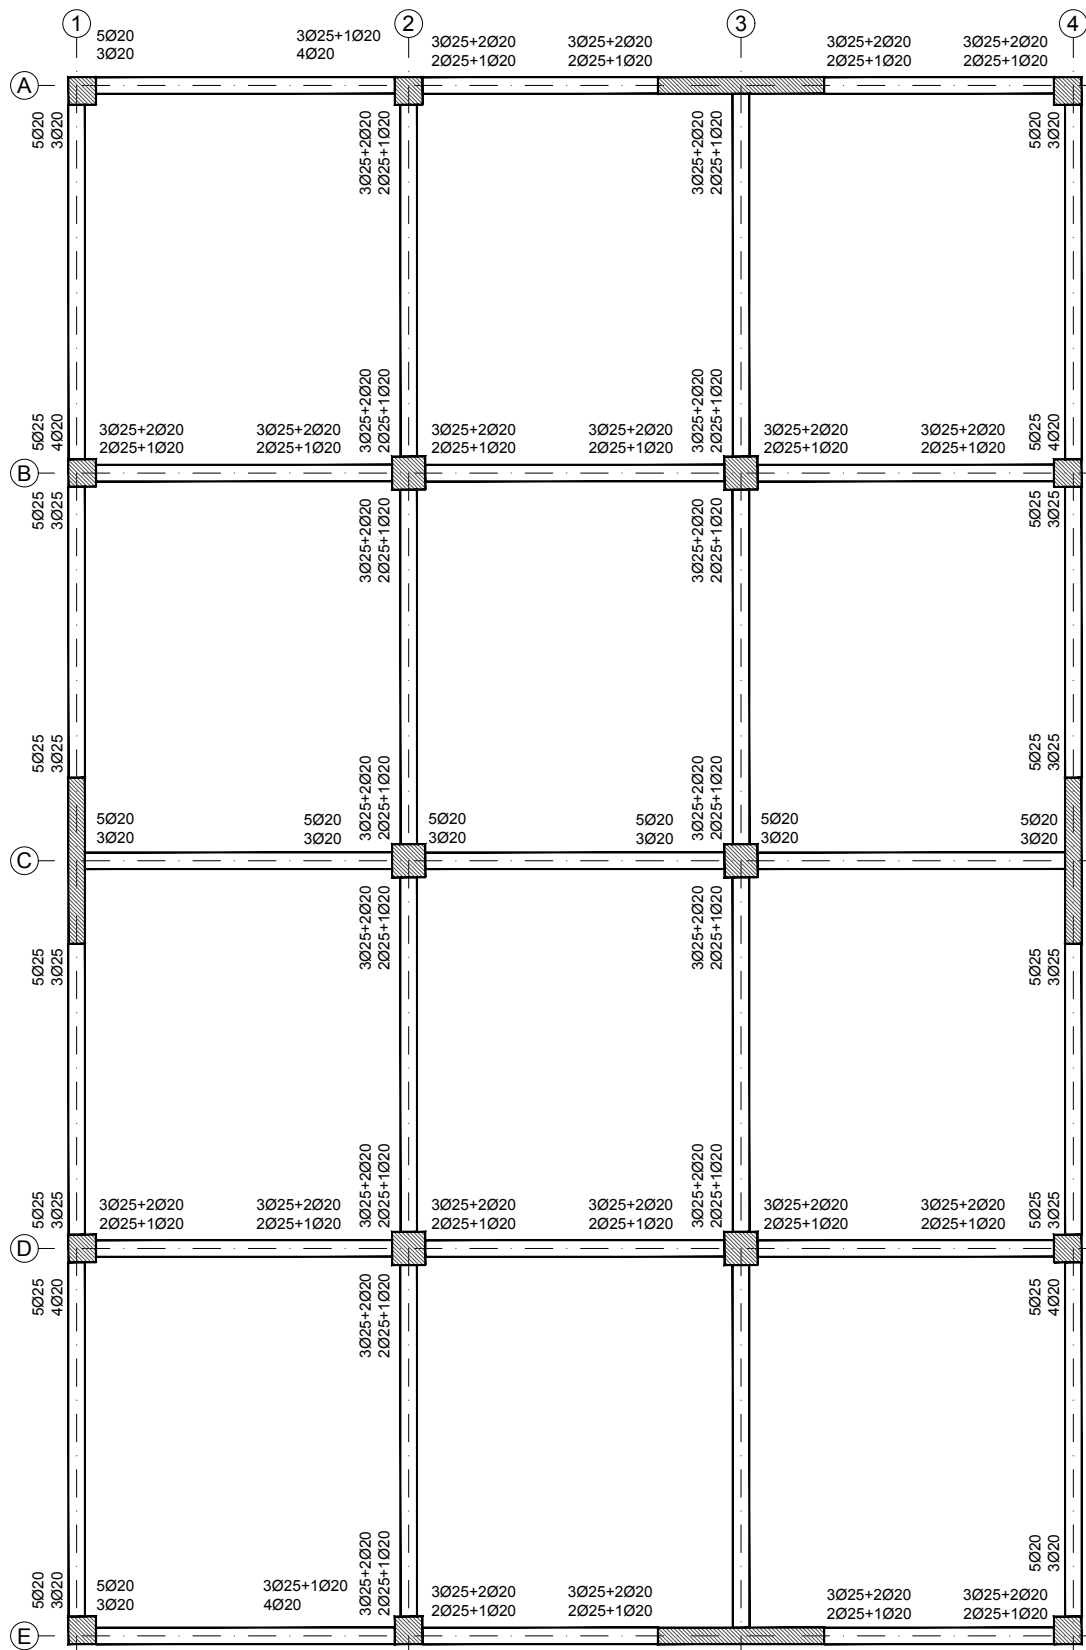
Armadura longitudinal das vigas – Piso 1.
